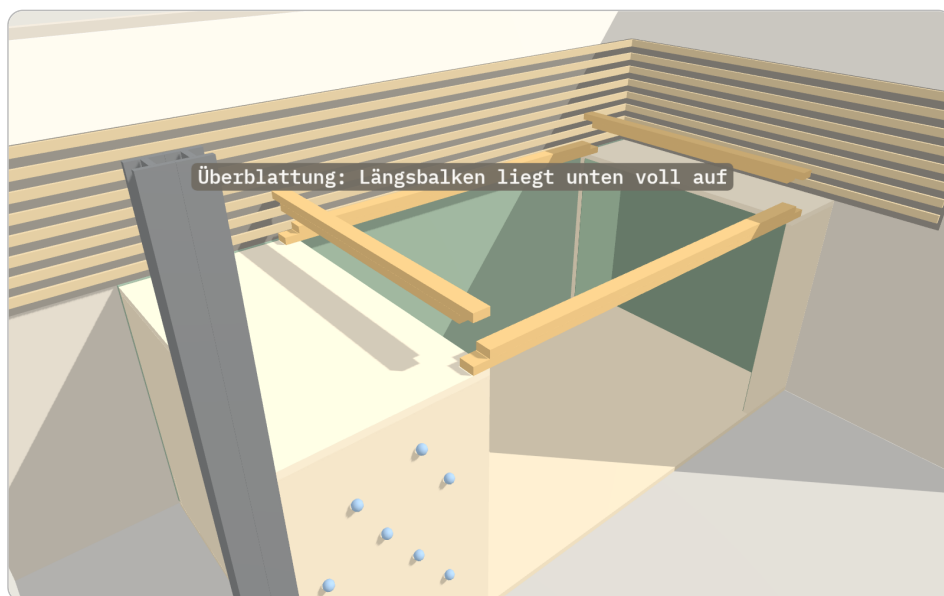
Überblattung in der Explosionsansicht — Längsbalken unten durchlaufend, Querbalken oben durchlaufend
